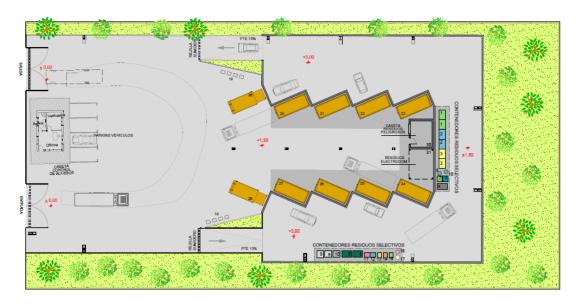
Planta proyectada del Ecoparque. Fuente propia.
